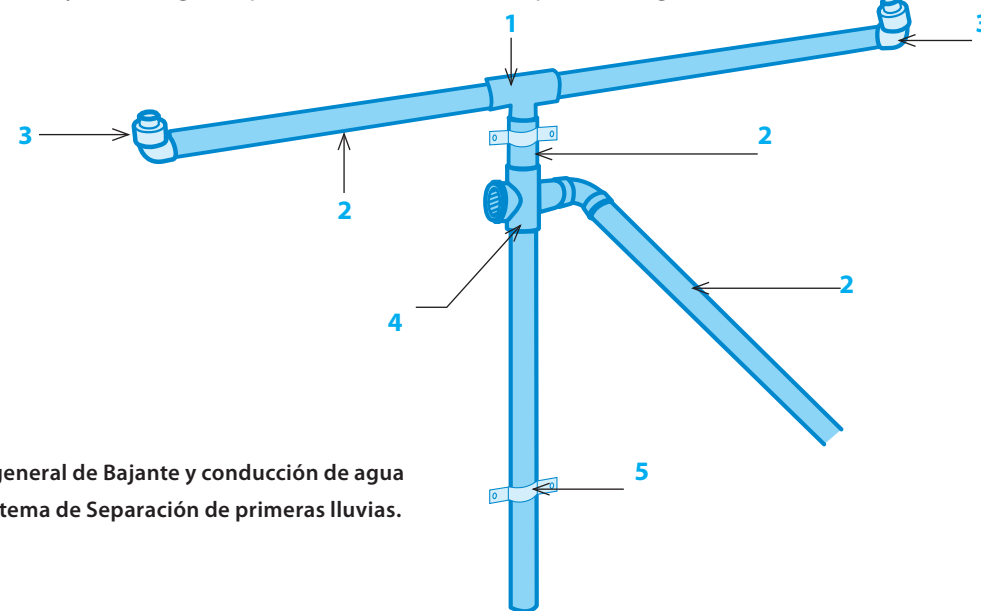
Armado general de Bajante y conducción de agua con el Sistema de Separación de primeras lluvias.
